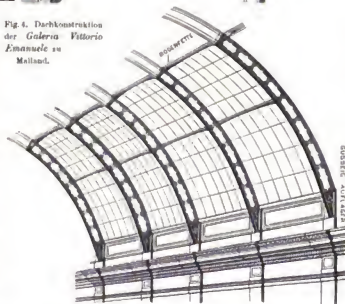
Dachkonstruktion der Galeria Vittorio Emanuele zu Mailand.
